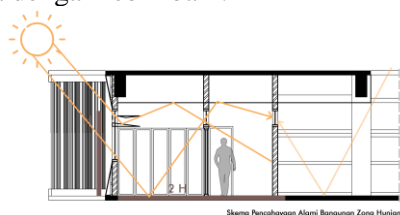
Skema pencahayaan light shelf pada bangunan publik
